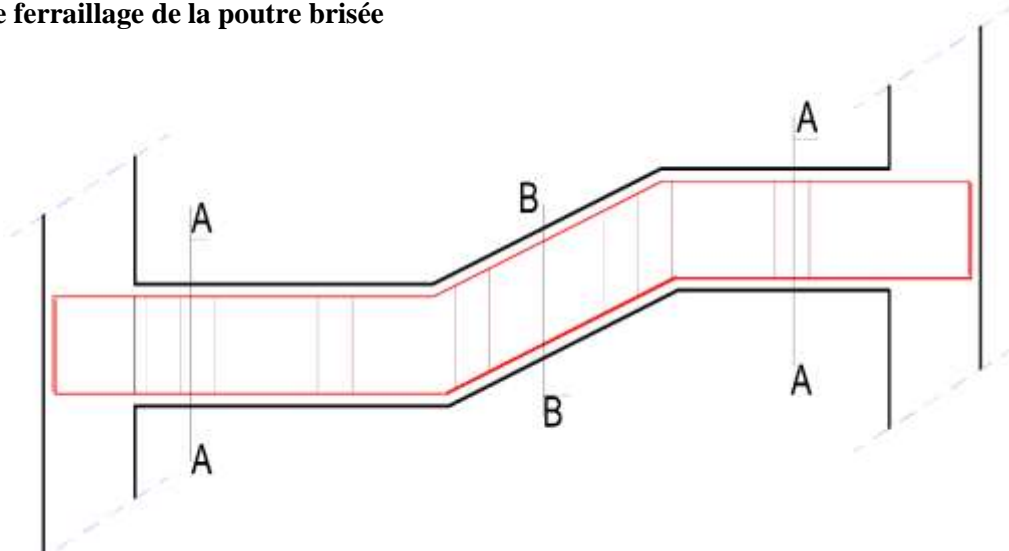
Schéma de ferrailage de la poutre brisée coupe longitudinale.
